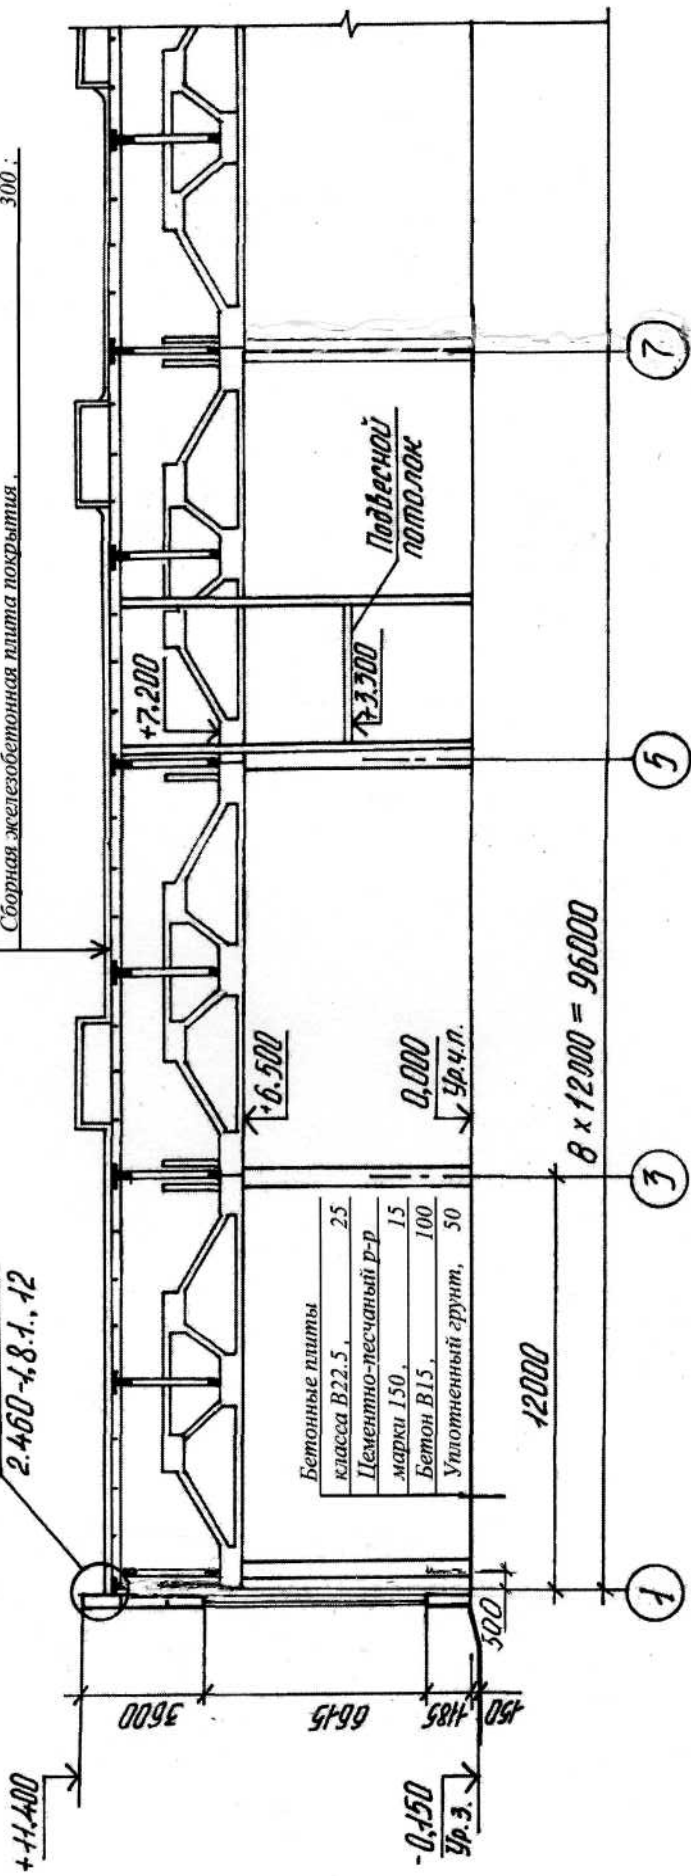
Схема продольного разреза промышленного здания с покрытием из железобетонных сегментных безраскосных ферм по подстропильным конструкциям и зенитными фонарями
